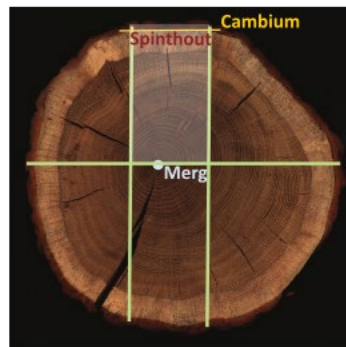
Twee, drie tot vierzijdig gerechte balk uit derde uit halve stam
